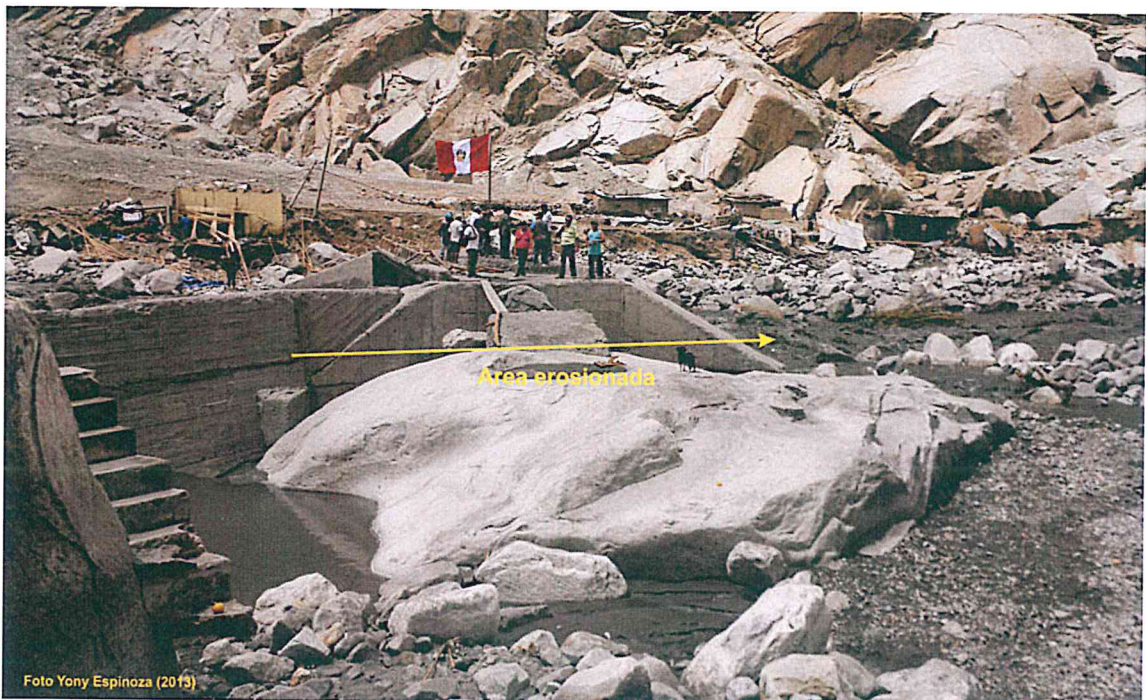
Puente Mayush, se muestra la erosión de la rampa de acceso al puente erosionada.
